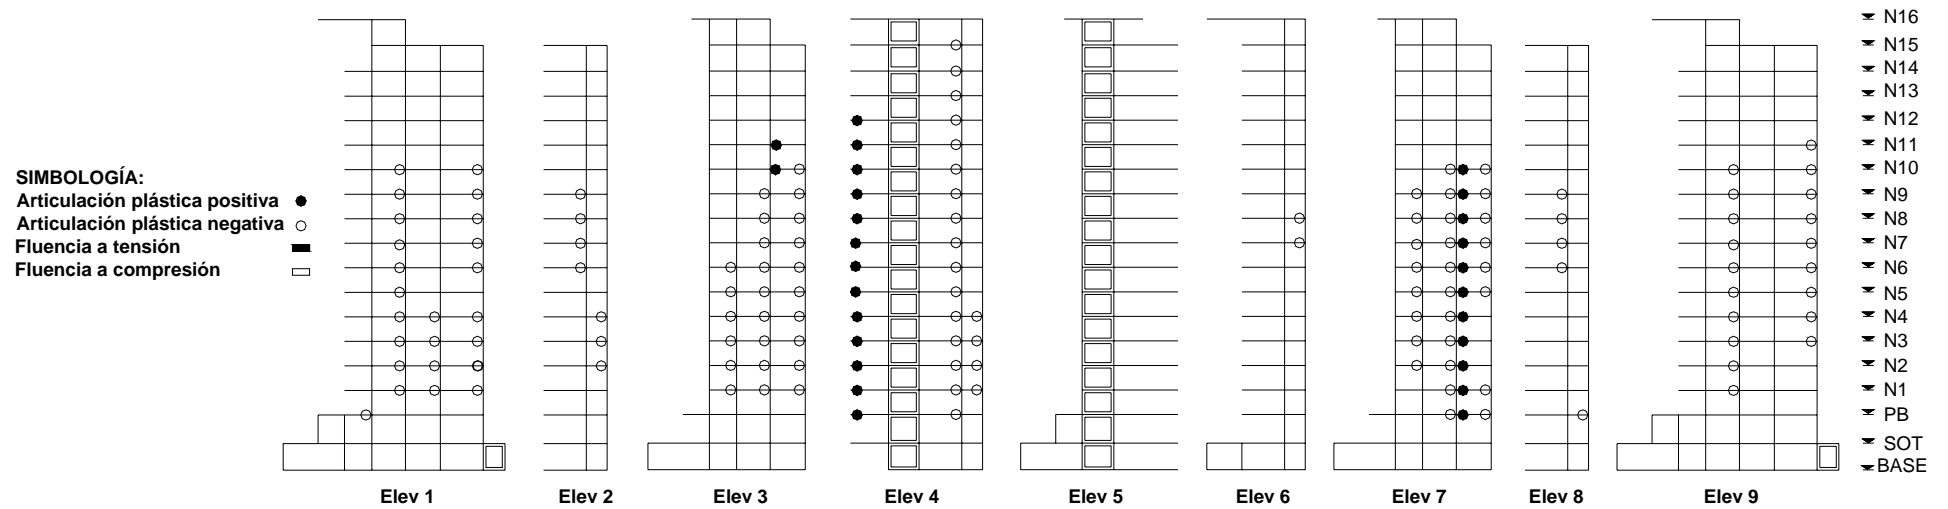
Formación de articulaciones plásticas en vigas y columnas para la SIM64 a los 55.03 s
